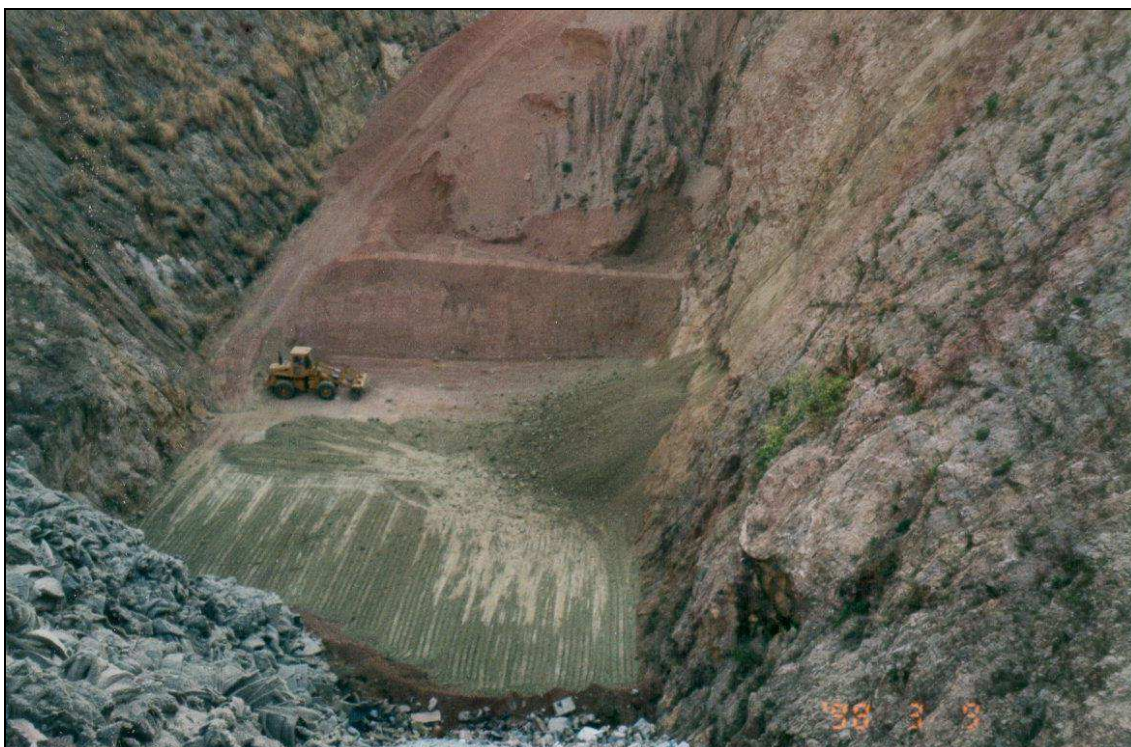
Lavori di impermeabilizzazione del fondo della discarica – Vista da Nord/Est
